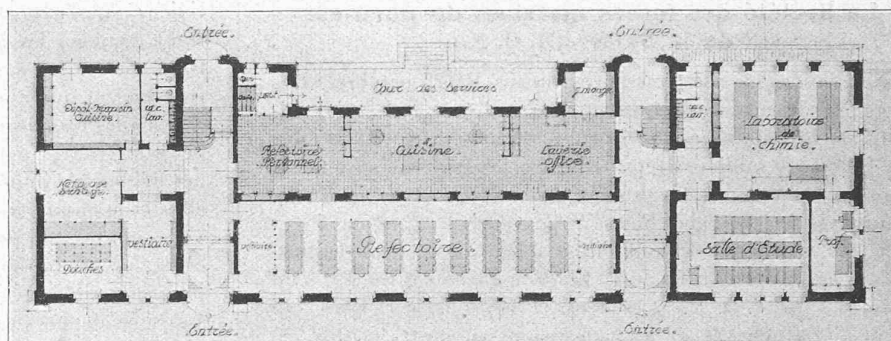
Plan du rez-de-chaussée inférieur. — 1 : 500.
